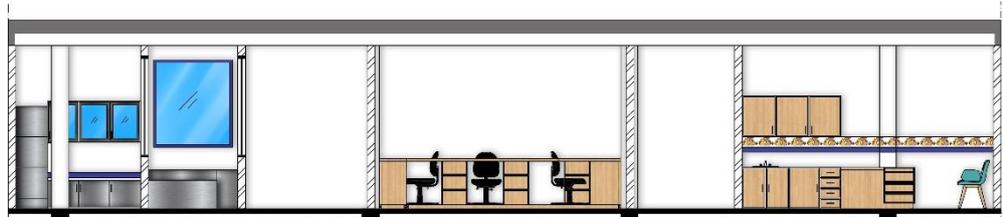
Layout Denah Khusus Klinik Anjing dan Kucing
